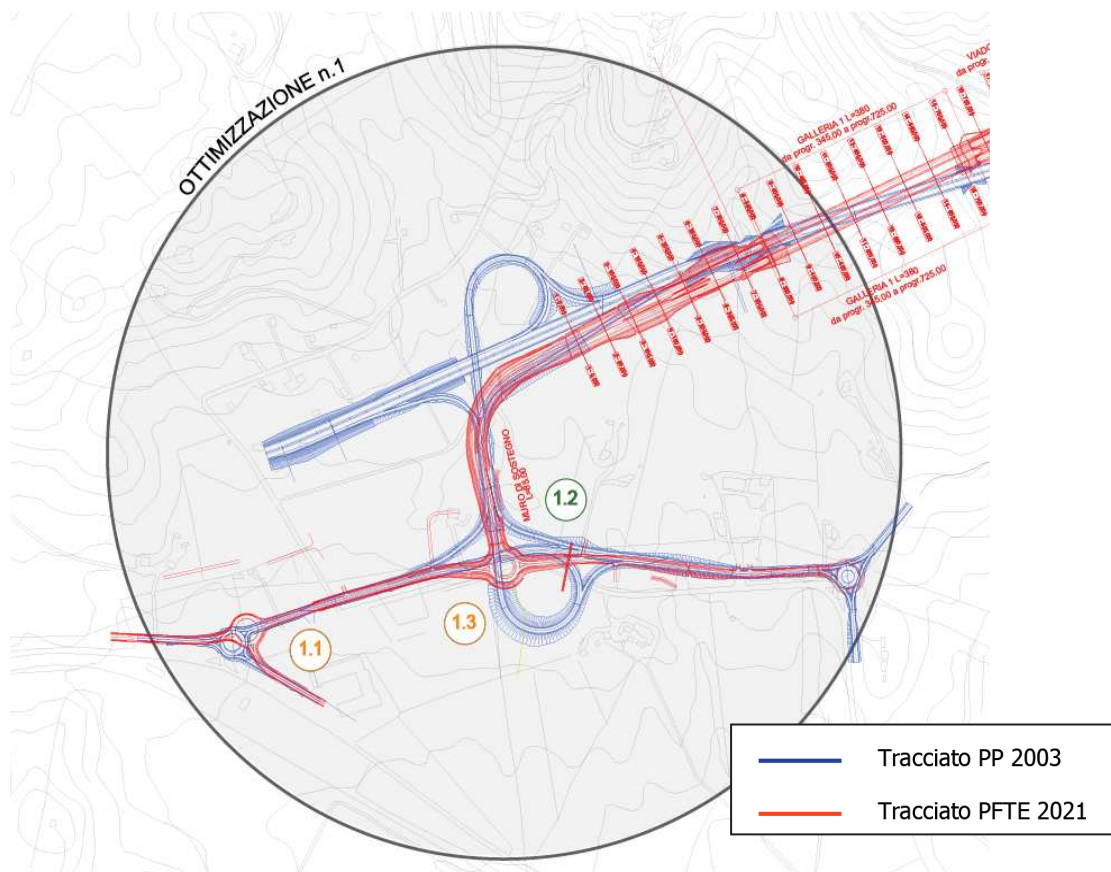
Stralcio sovrapposizione tracciati – Svincolo di Olbia
